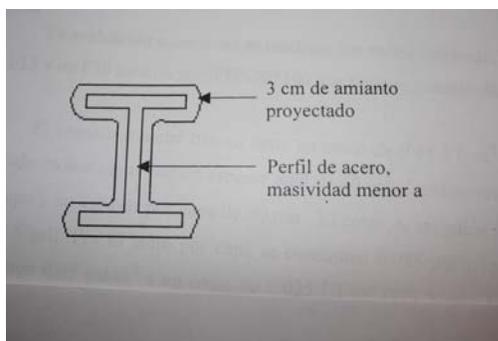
Protección de columna de acero con amianto proyectado (F 90).
